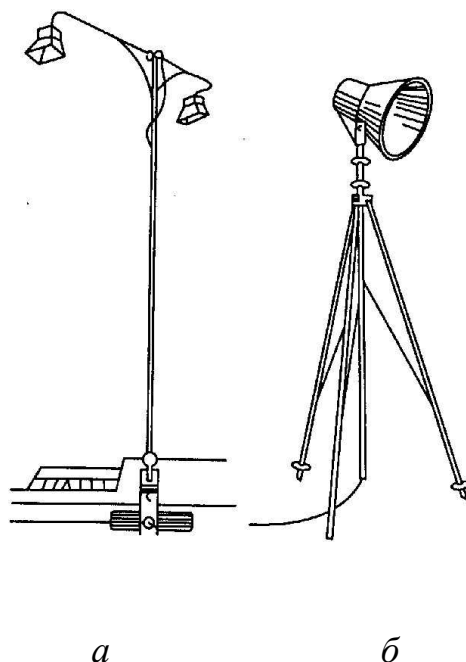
Инвентарные стойки со светильниками: *а* – стойка телескопическая типа ИПСК-2 с двумя светильниками для освещения работ по кирпичной кладке; *б* – стойка типа ПТС-2 с одним светильником для местного освещения рабочих зон
